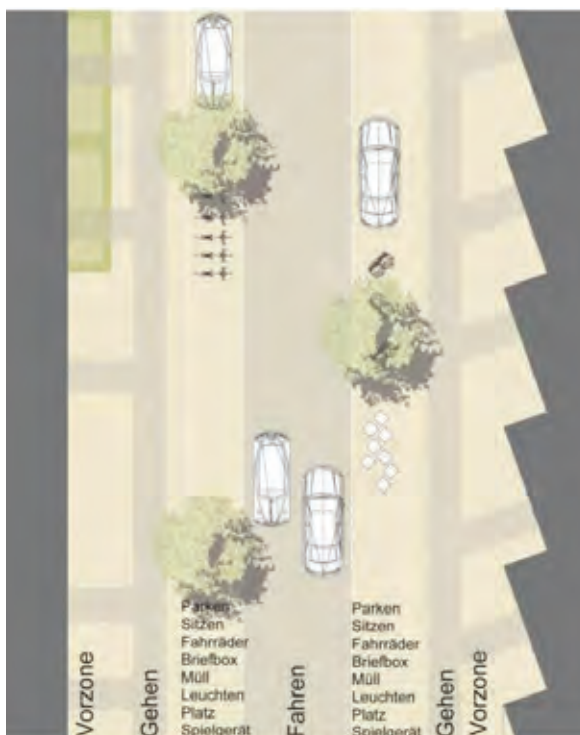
Variante der Straßenraumzonierung Kornstraße (andreas schneider architekten)
